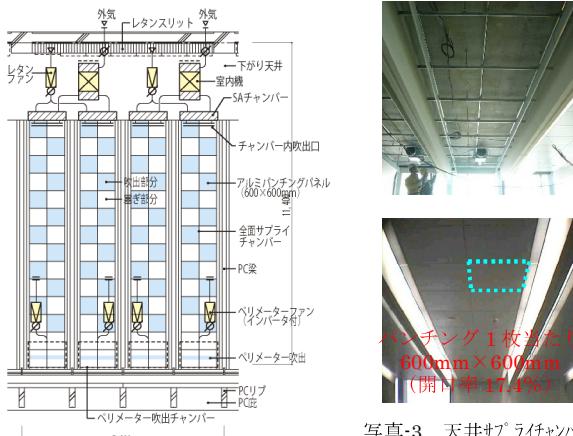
天井輻射冷暖房方式概要 上:天井施工前 下:天井施工後
